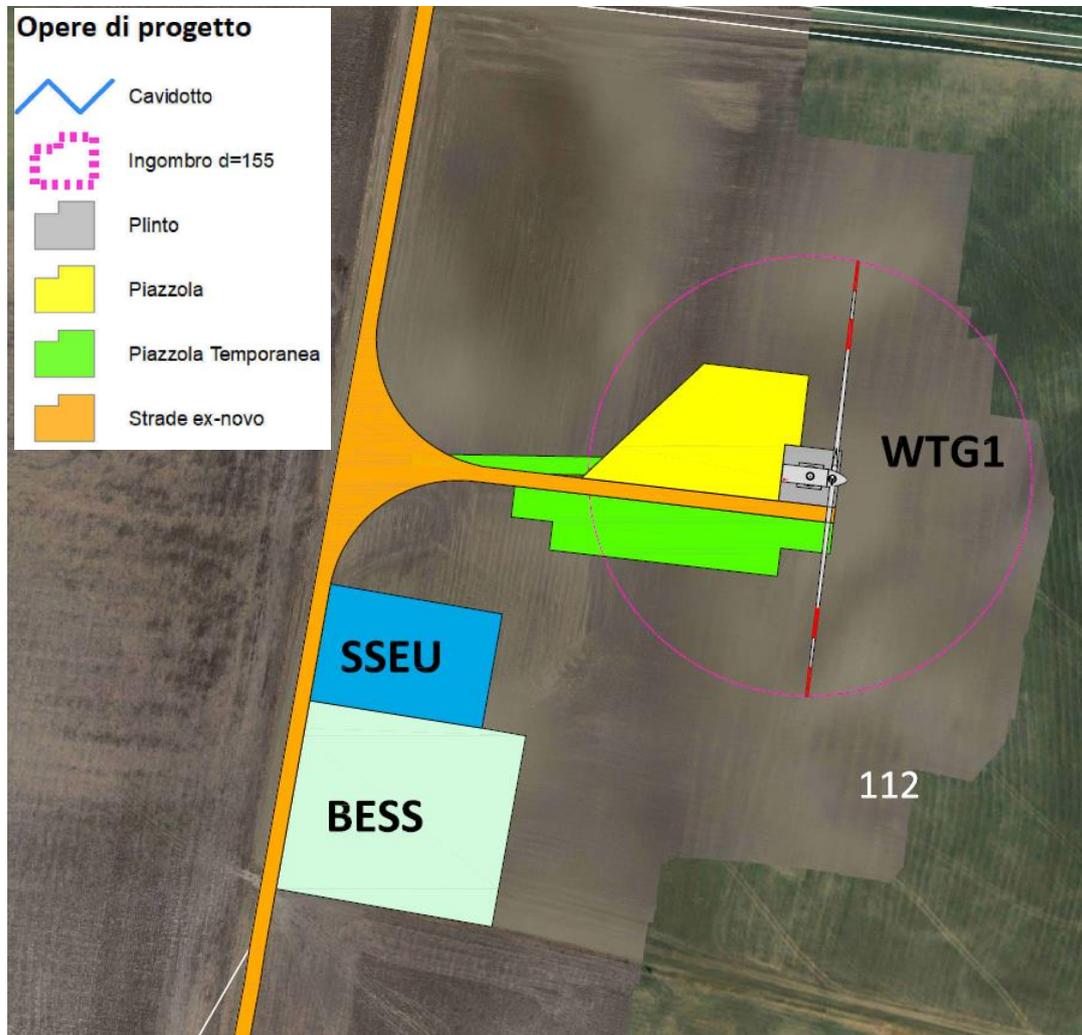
Stralcio planimetrico aree Bess e SSEU
